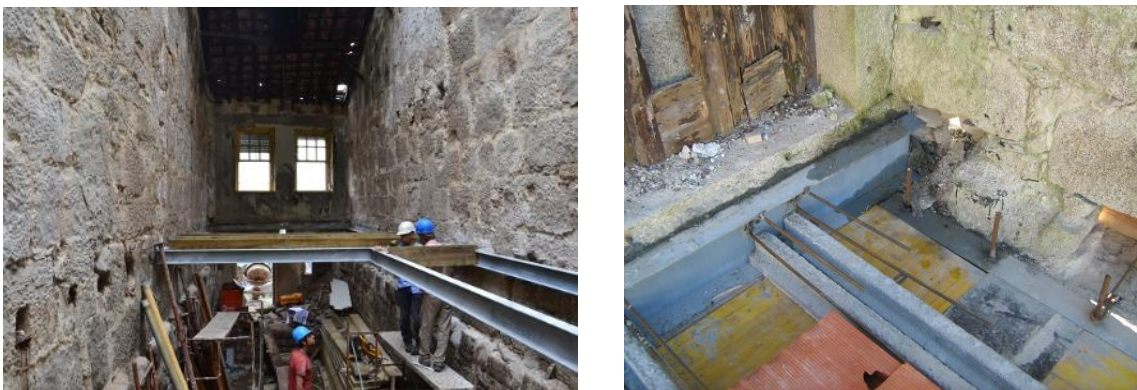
Exemplos da estrutura proposta para a reabilitação - Viga encastrada na parede de granito
